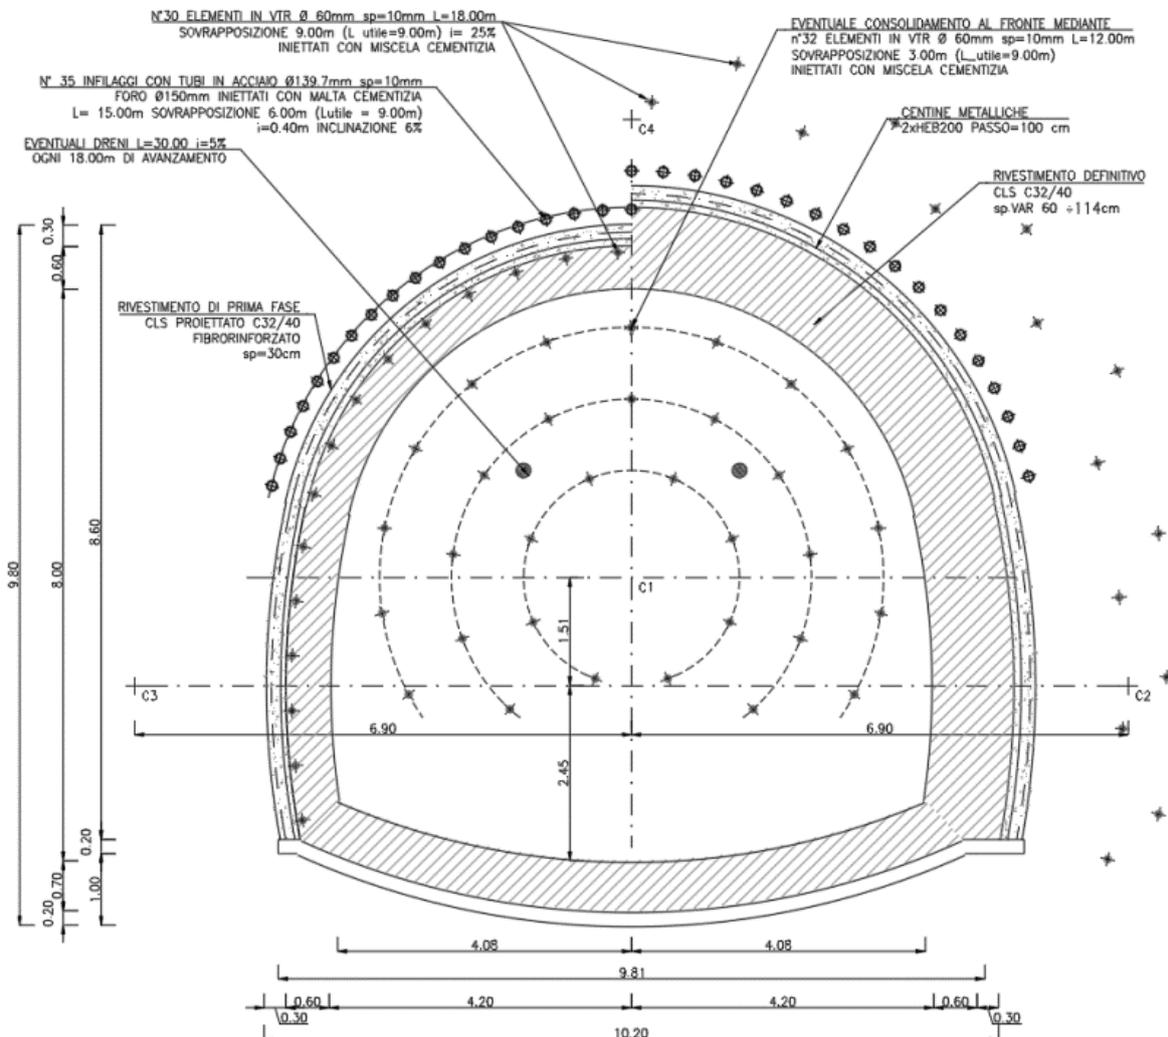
Sezione tipo GA4: Geometria del cavo e interventi di sostegno
